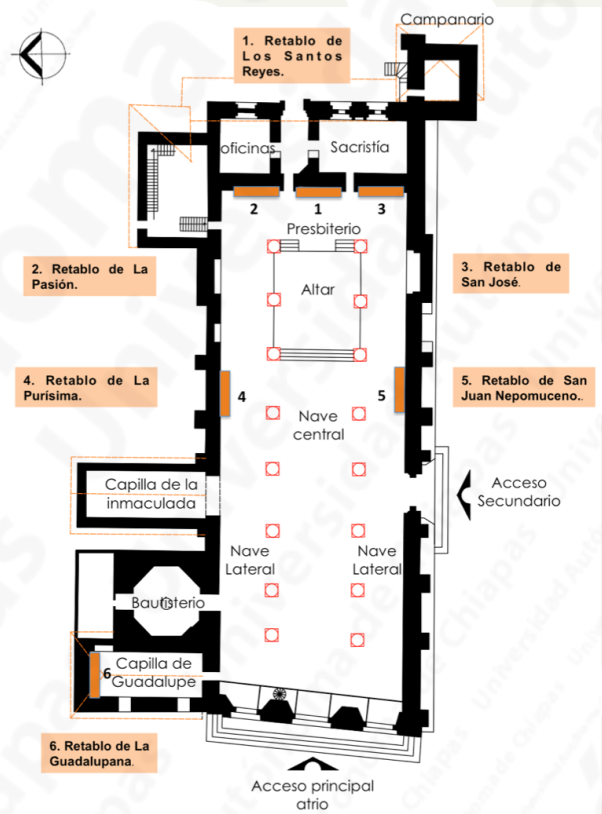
Planta arquitectónica de la Catedral con la ubicación de los retablos. Dibujo: JFGC.
